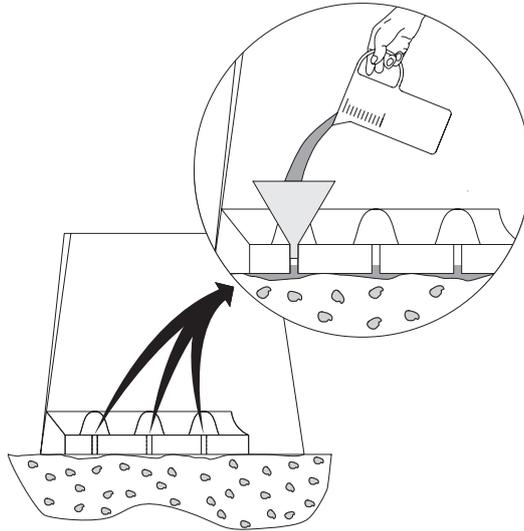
Zócalo de hormigón: elaboración de un asiento plano
